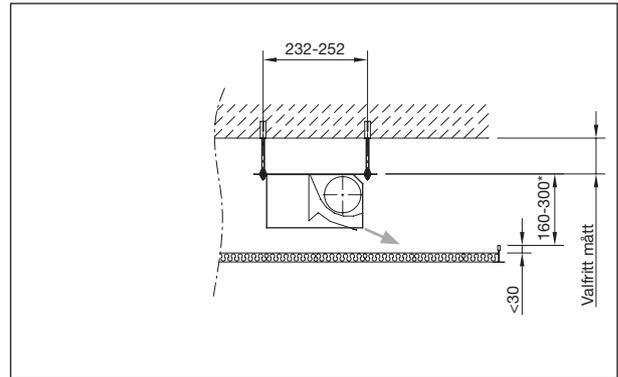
Abmessungen für die hängende Montage bei Inselmontage.
